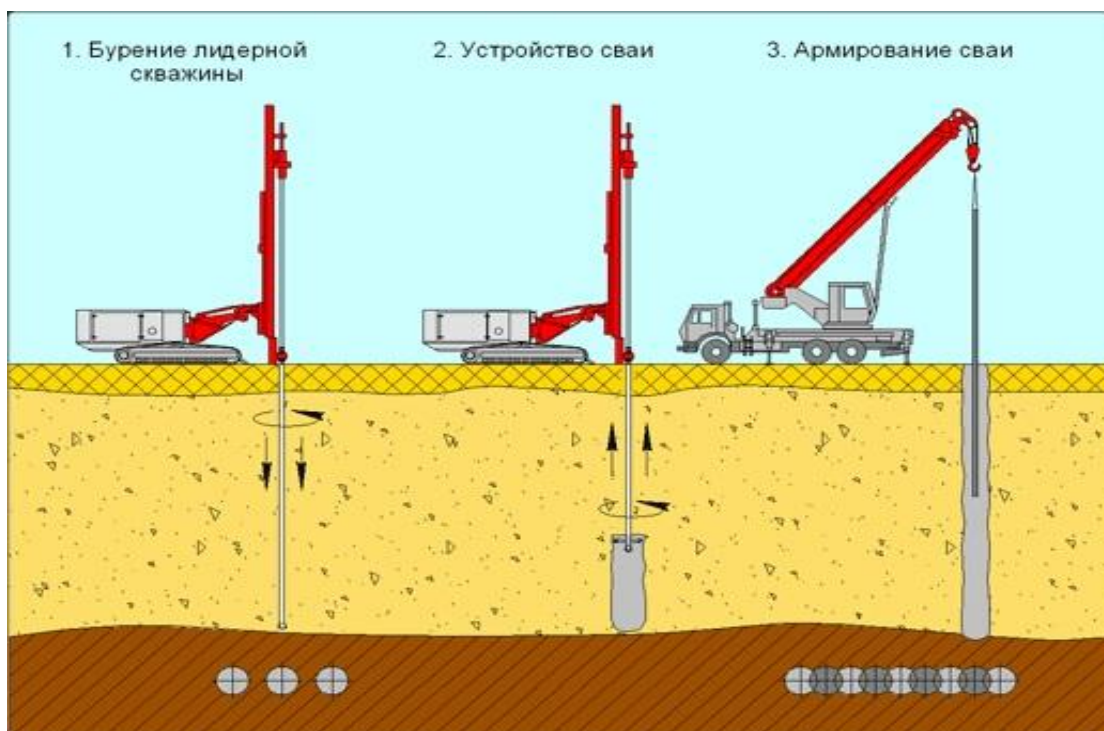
Устройство грунтоцементных свай (jet свай)
